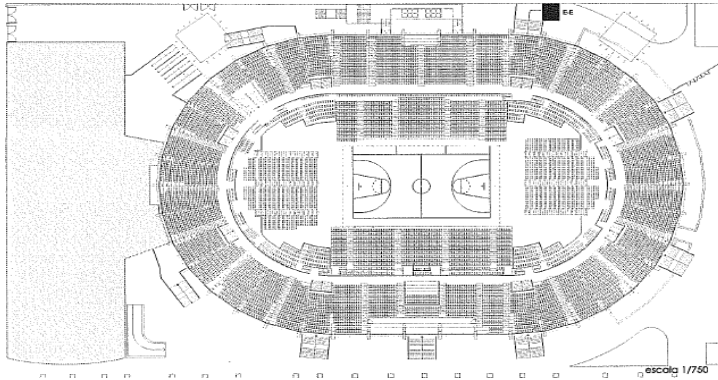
Plano de Situación Escalera E-E Ampliación. Plano 30.
